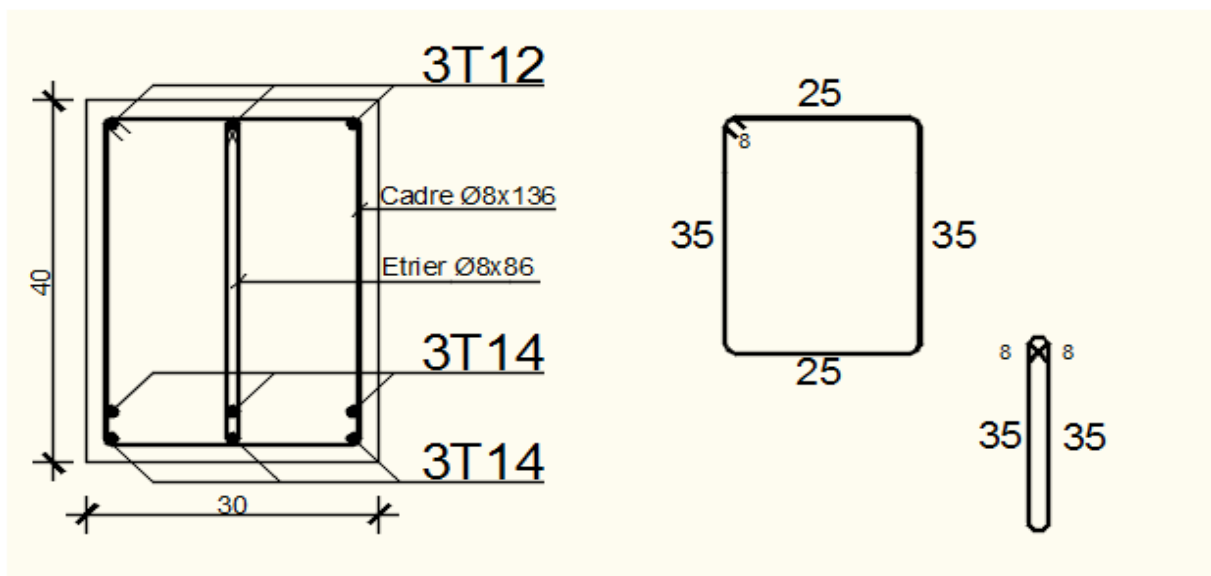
Dessin de ferrailage de la poutre palier en travée.
